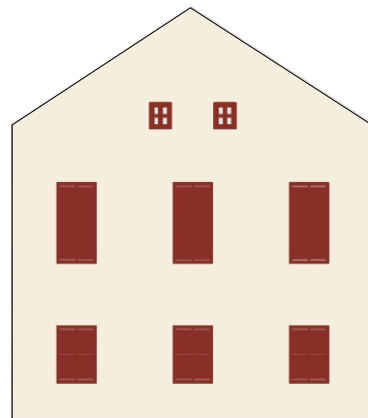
E 23: LEVANTAMENTO FACHADAS. Fonte: Acervo pessoal.
